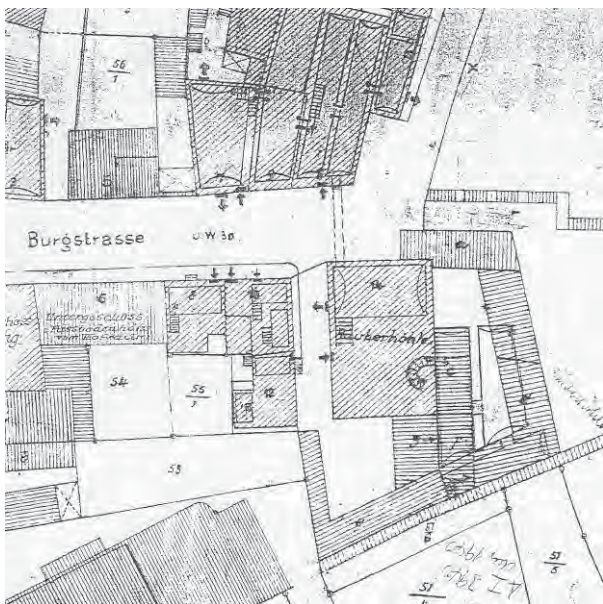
Kellerplan der Stadt Ravensburg, 1940er Jahre, Ausschnitt. StA Ravensburg, Gebäudeakte Burgstrasse 14.
